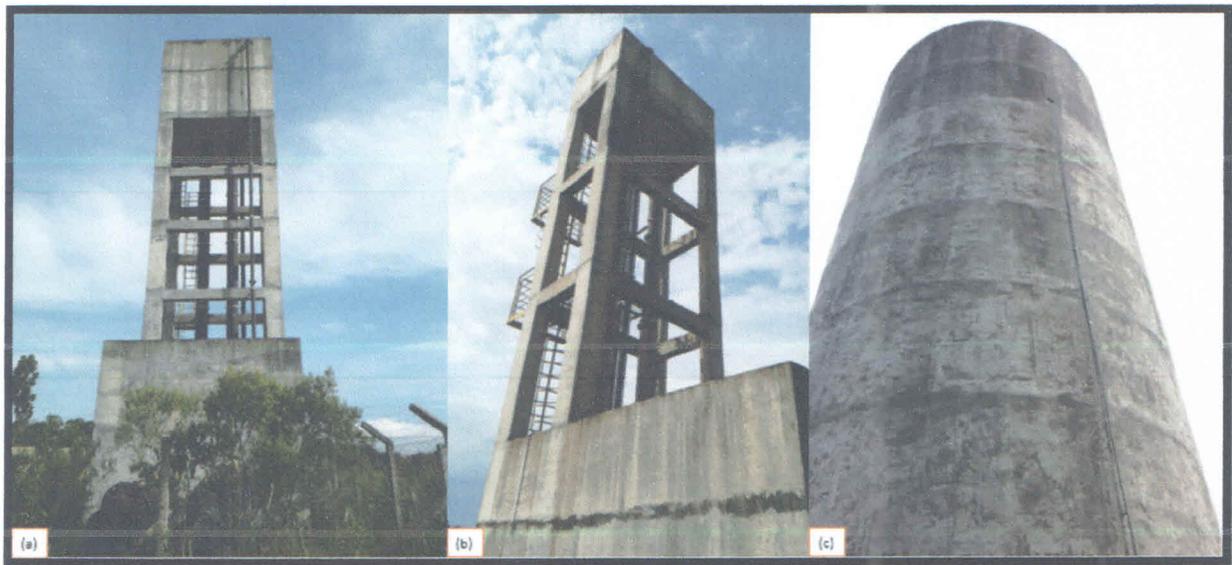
Imagens do Sistema de adução da barragem do Rio Cravo. a) Vista do TAU I; b) Vista do TAU II; c) Vista da Chaminé de Equilíbrio.
